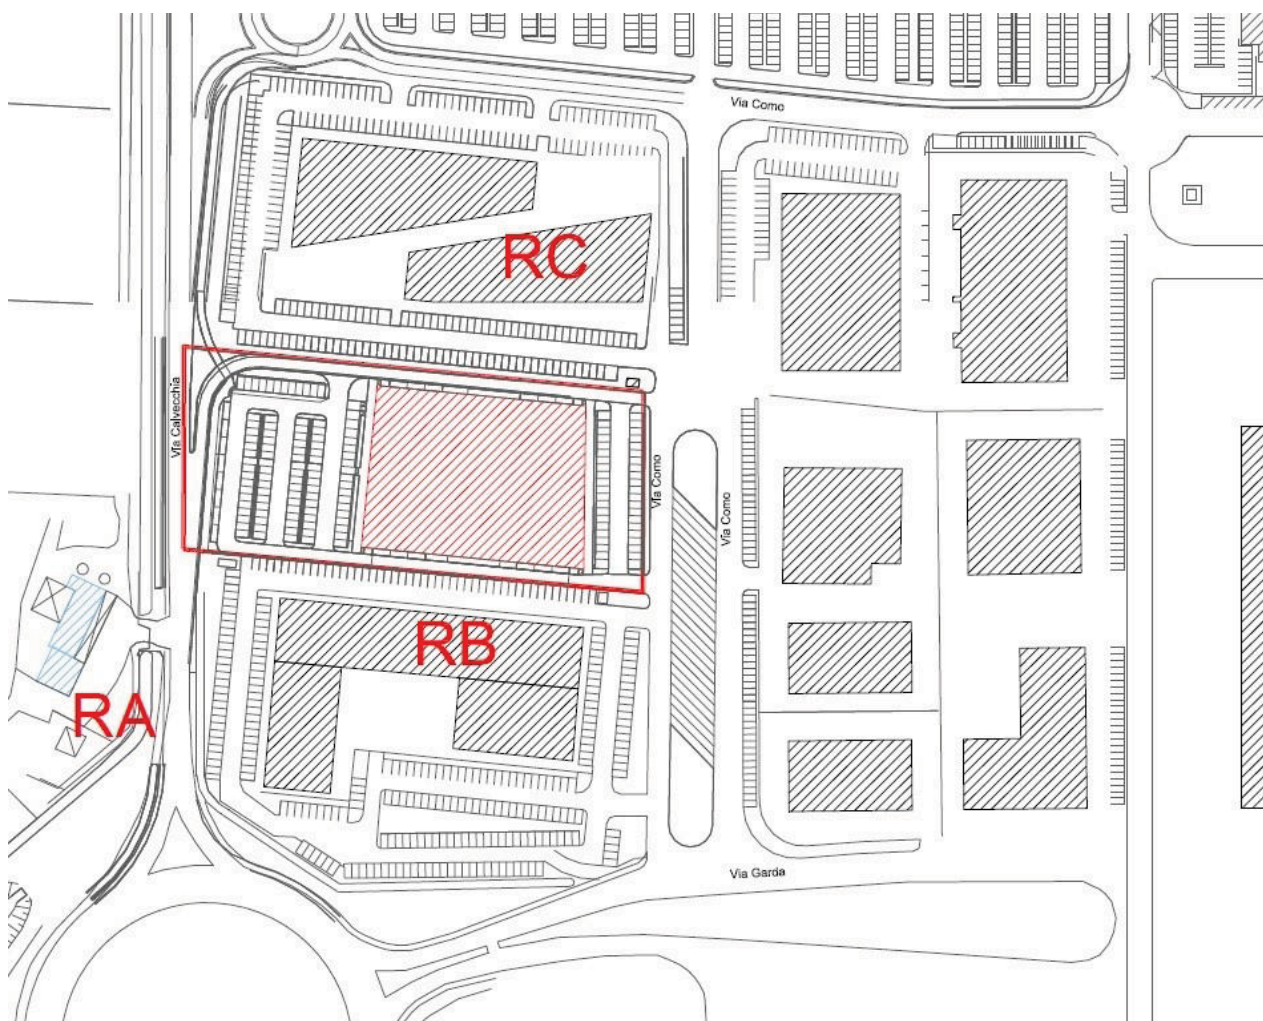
Planimetria dei principali ricettori posti nelle vicinanze dell'intervento.
